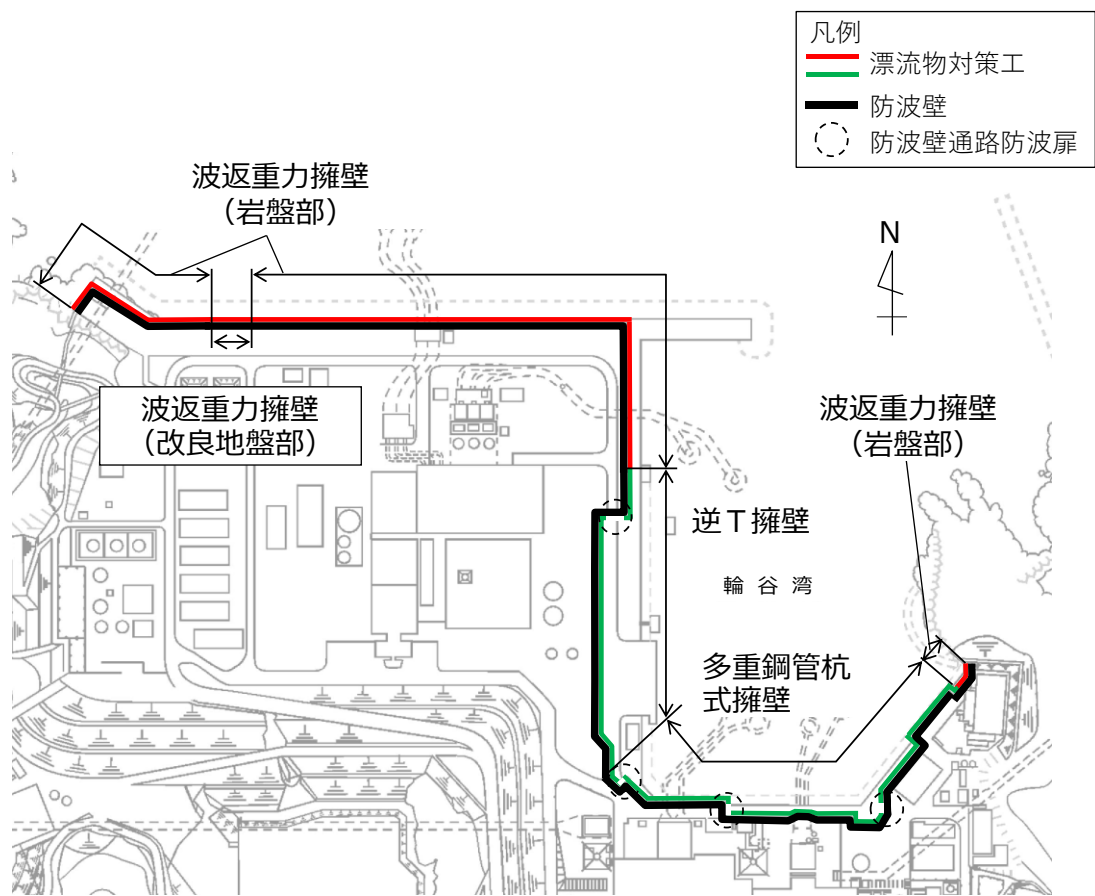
漂流物対策工（鉄筋コンクリート版）の位置図
